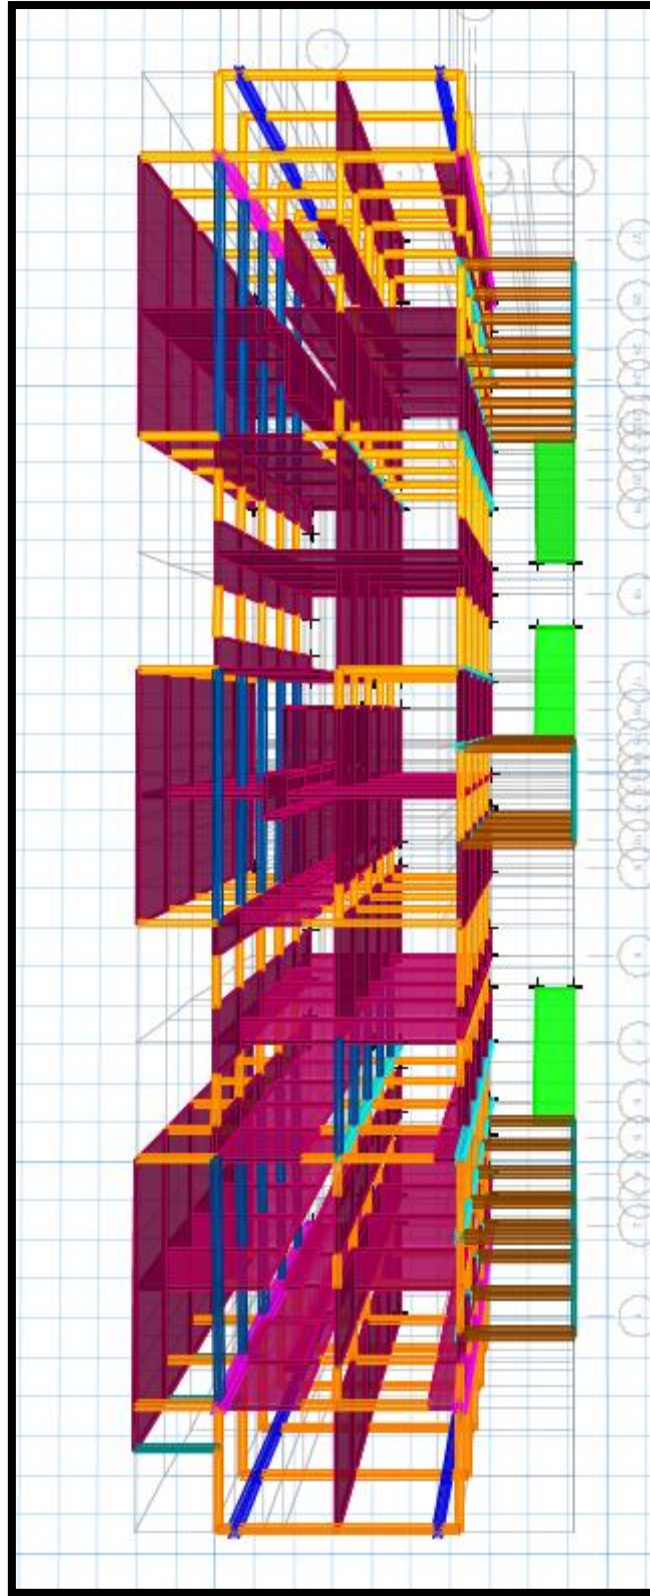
Vista de Vigas y Muros de Ductilidad Limitada
